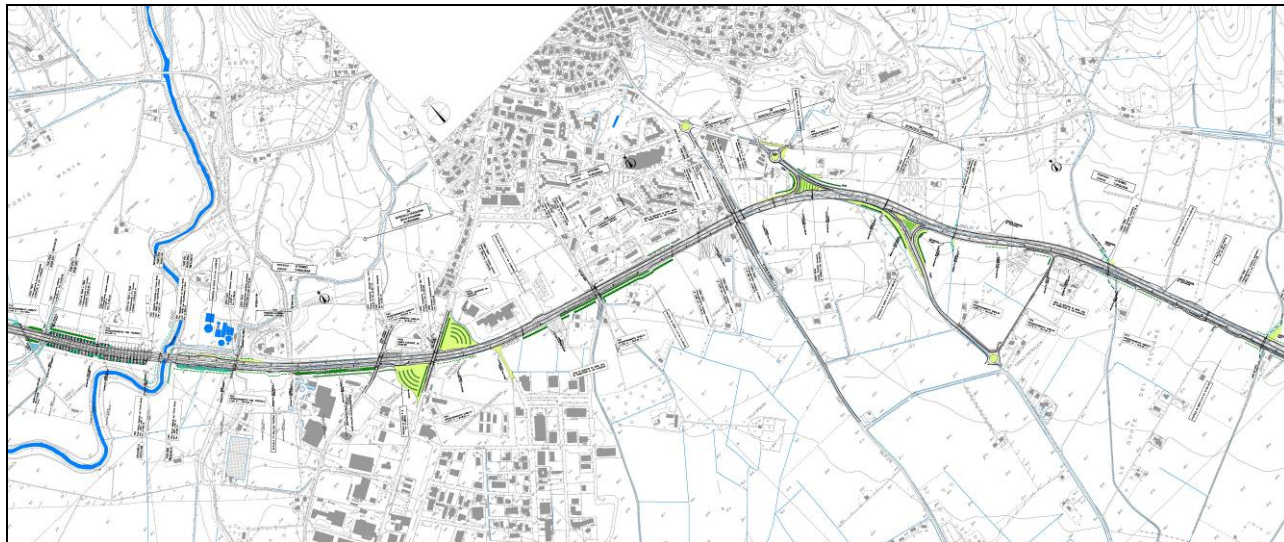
La planimetria del progetto di inserimento paesaggistico all'altezza di Tarquinia.
